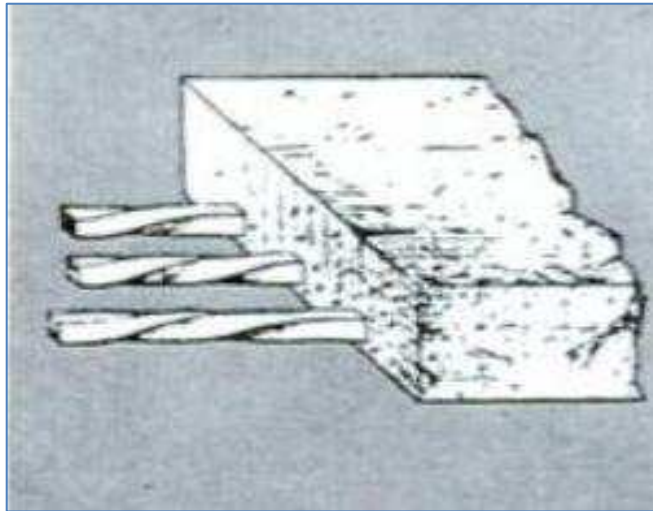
Ward construye el primer forjado con viguetas metálicas
